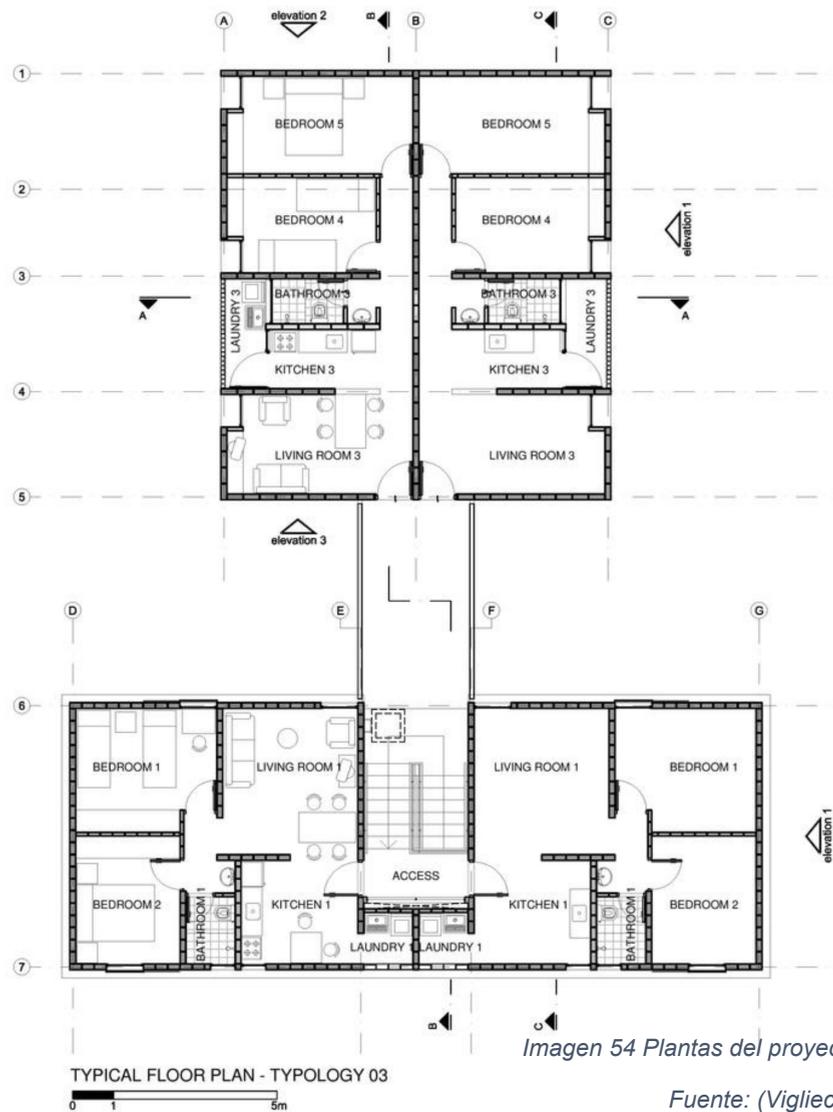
Plantas del proyecto urbanización del Jardim Vicentina.
